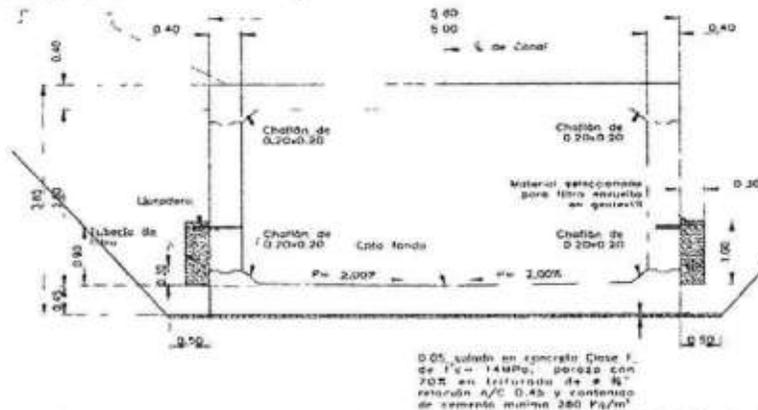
Sección del box culvert de 36.0x5.0x2.80m en Tramo Vial Gimai – Minas de Iracal.
